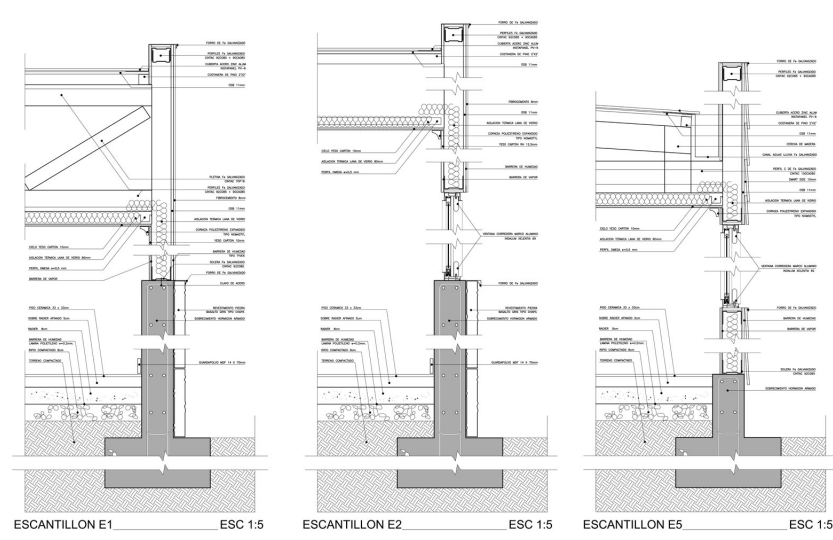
Ejemplo de planos de corte escantillón. (Fuente: Archimlynarz (2018))
